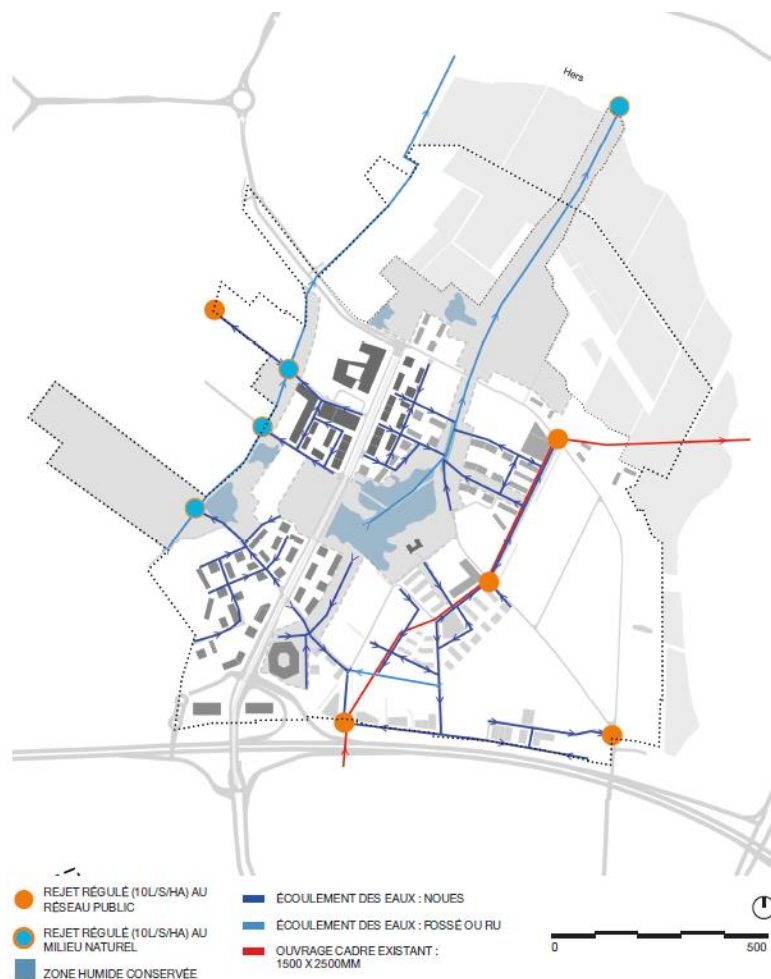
Plan de gestion des eaux pluviales (Source : MGAU, 2024)
